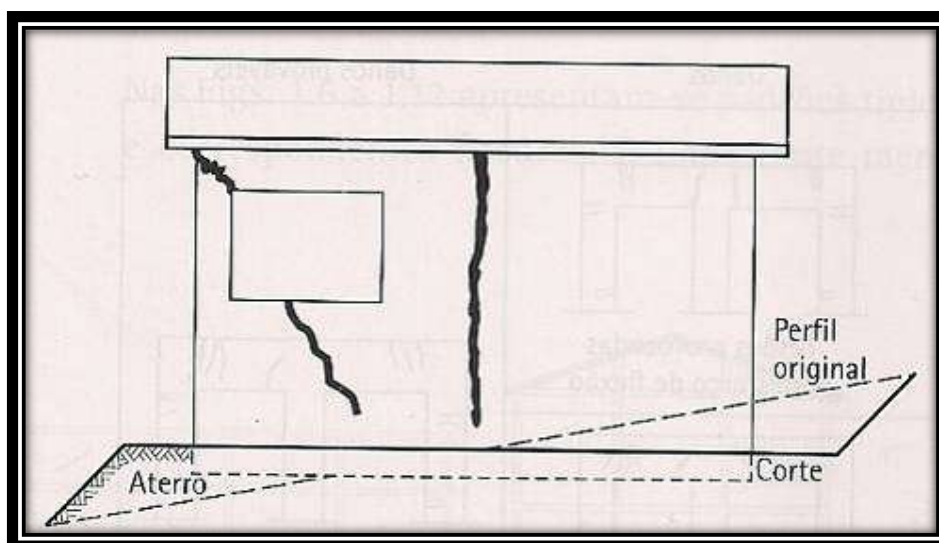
Provável fissuramento de edificação assente parte em corte e parte em aterro
